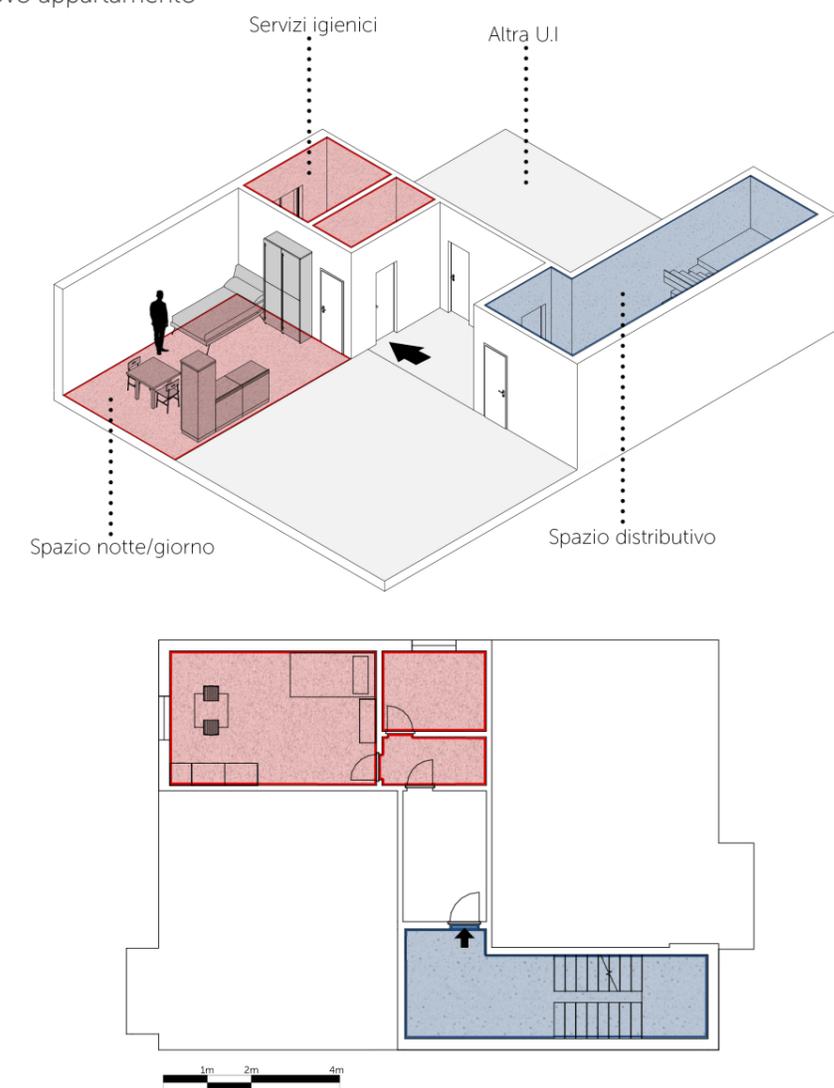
Vista 3D e pianta della disposizione interna del primo nuovo appartamento
